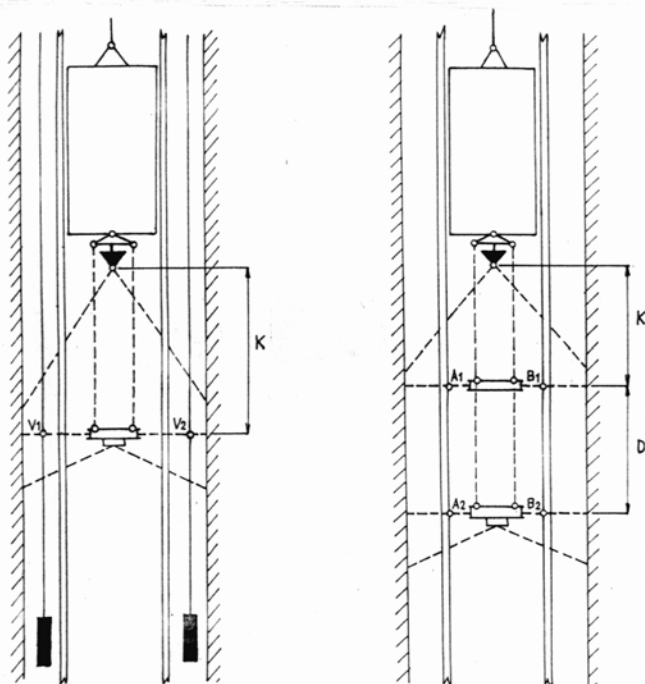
Rejestracja pionowego przekroju podziemnego korytarza metodą płaszczyzny światła; widoczne 4 sygnały stanowią podstawę rzutowego przekształcenia obrazu – wg. [Gutu, Tolea 1988]
